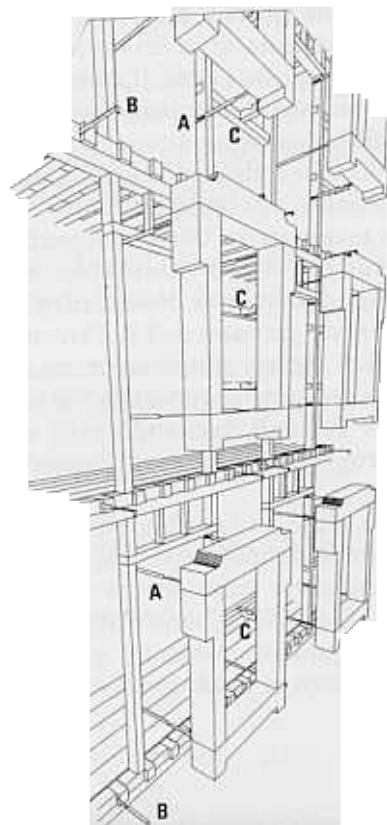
Disposição de sistema de gateamento metálico (a alvenaria é suposta invisível, para melhor compreensão das ligações):
